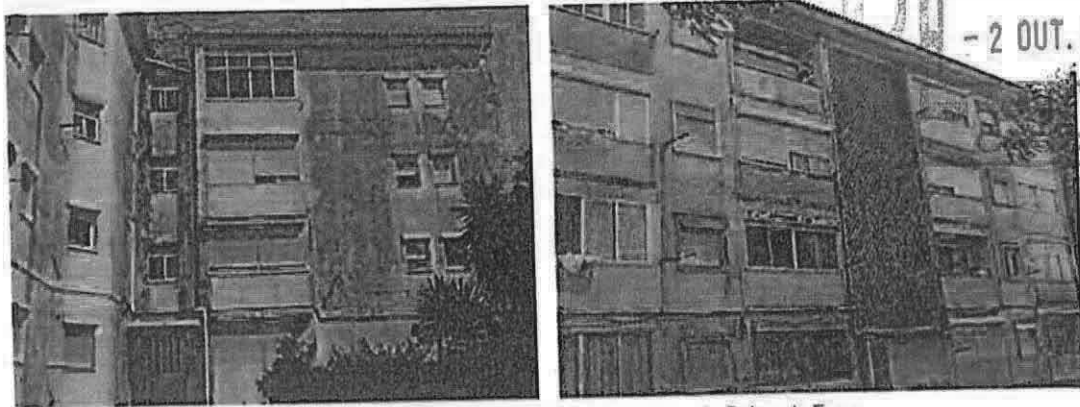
Estado de conservação das fachadas do Bairro da Torre
